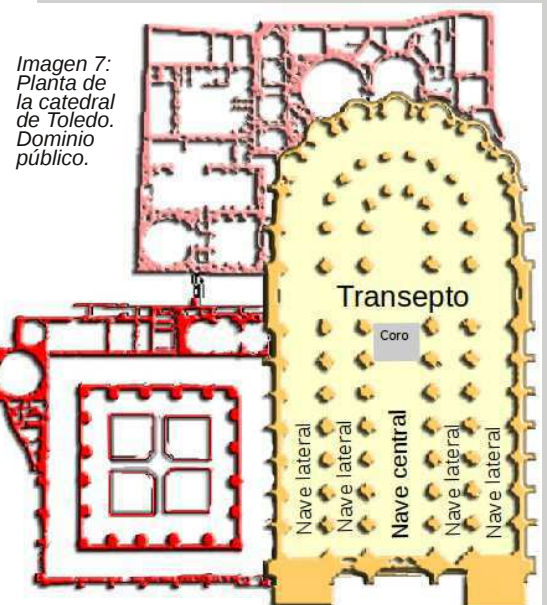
Planta de la catedral de Toledo. Dominio público.
